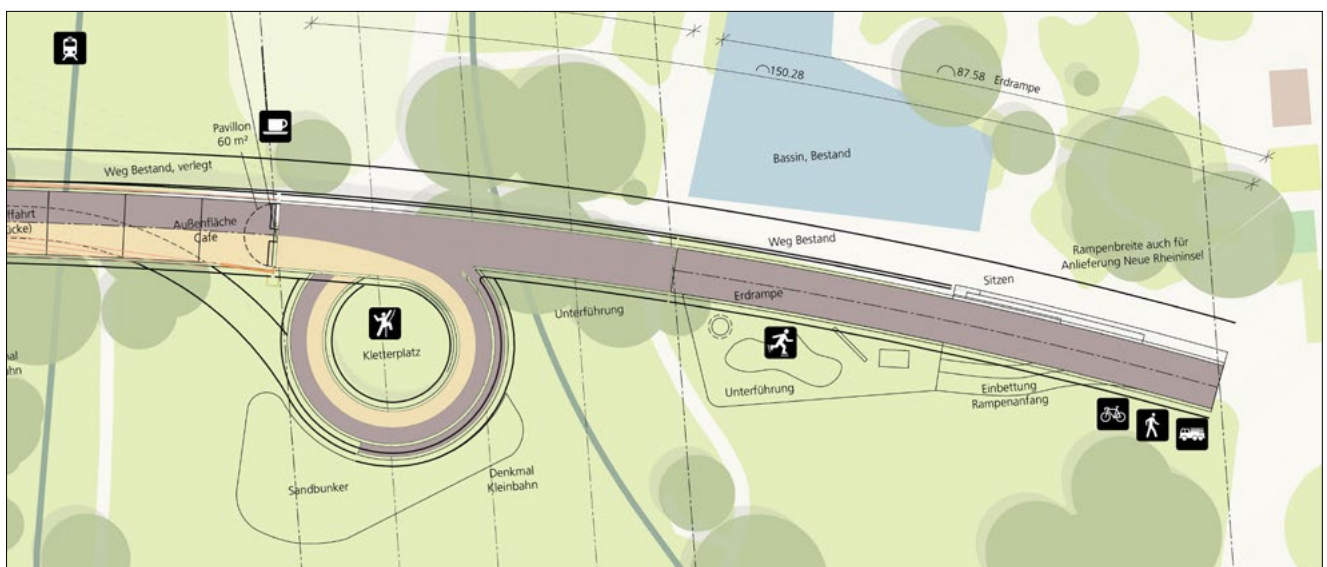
Grundriss rechtsrheinische Rampe
